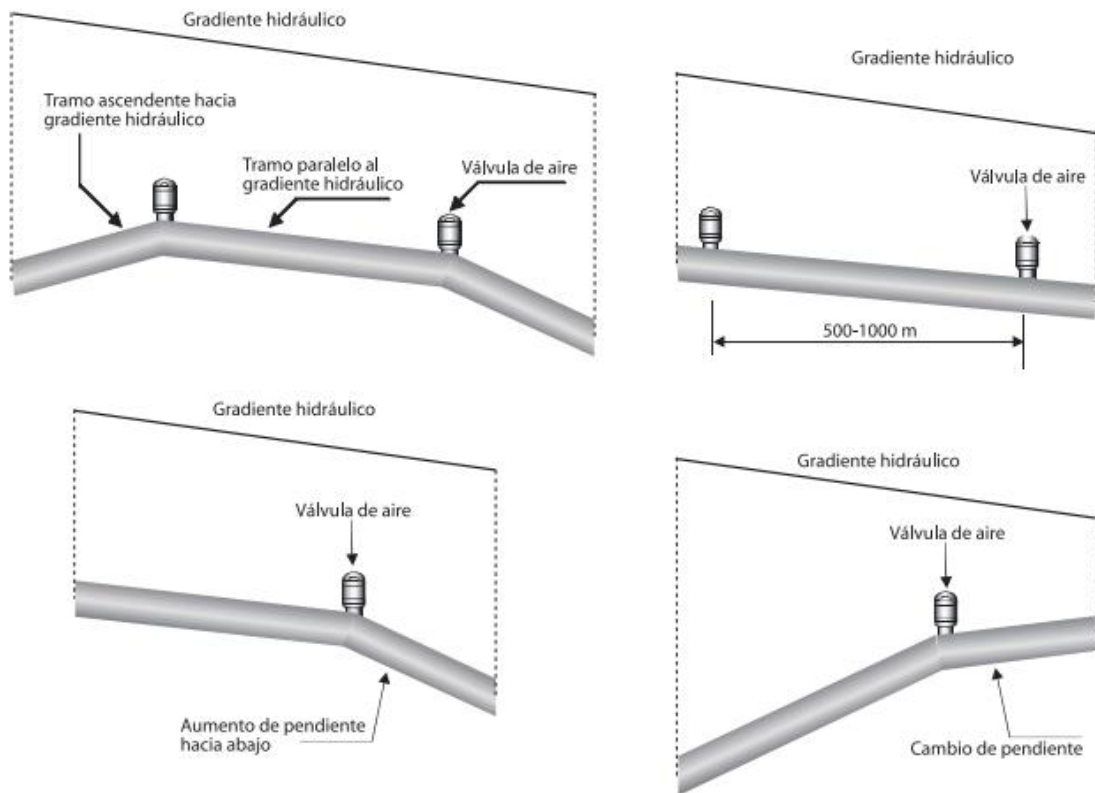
Esquema de emplazamiento de válvulas para la eliminación aire comprimido en tuberías de sistema de conducción. Fuente: Hidroval (2013)
